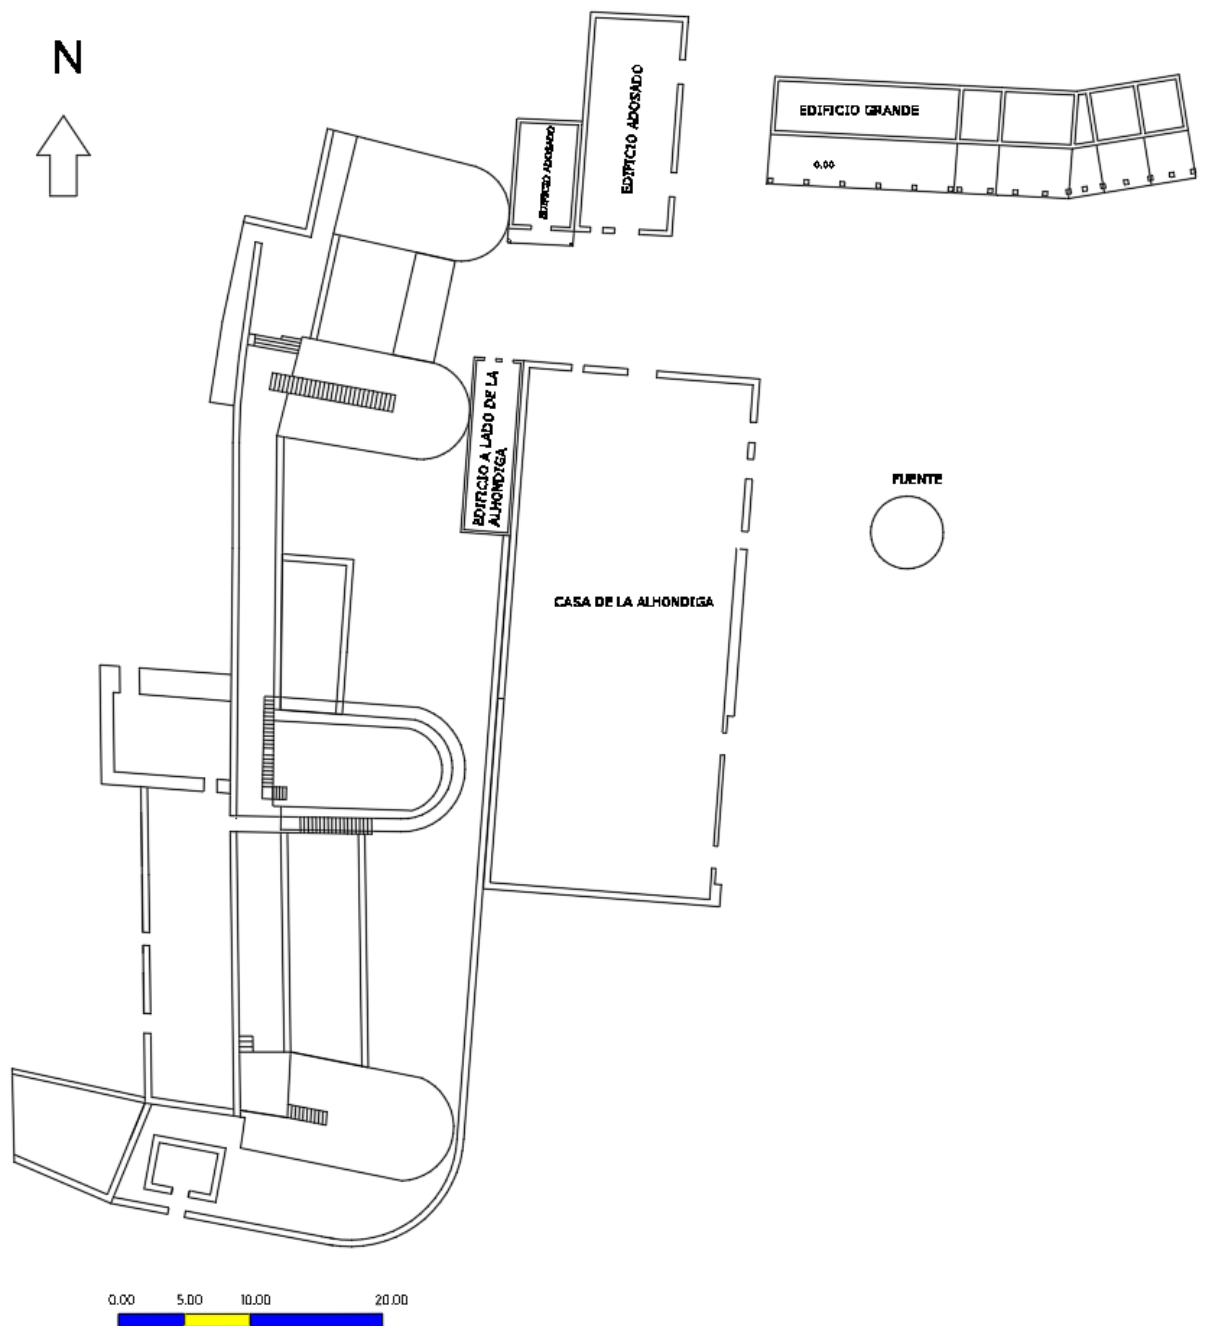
Planimetría Puerta de Alcázar extramuros. Simón Cardozo Mamani.
